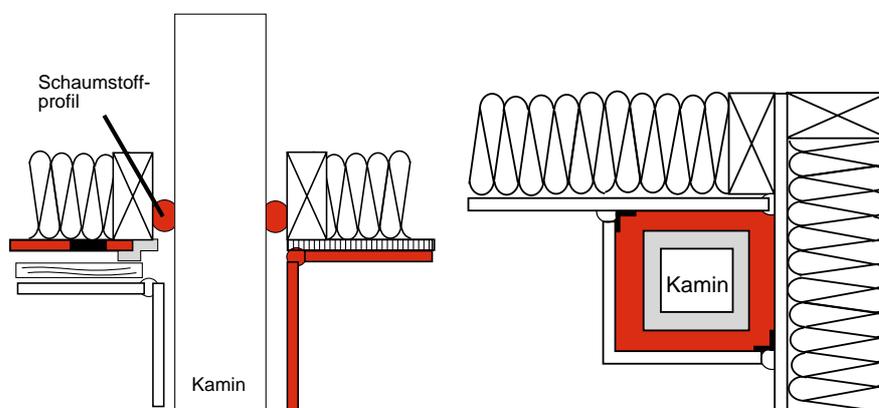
Abdichtungsvarianten für einen Kamin in einer Holzdecke.
